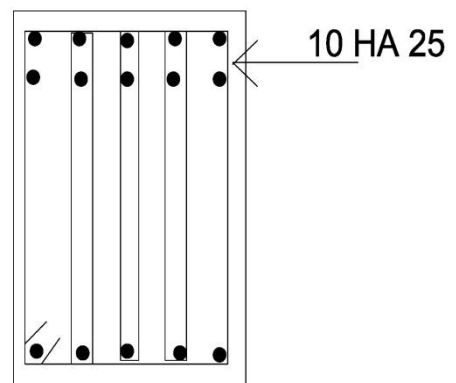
Coupe transversale en travée d'une nervure transversale.
